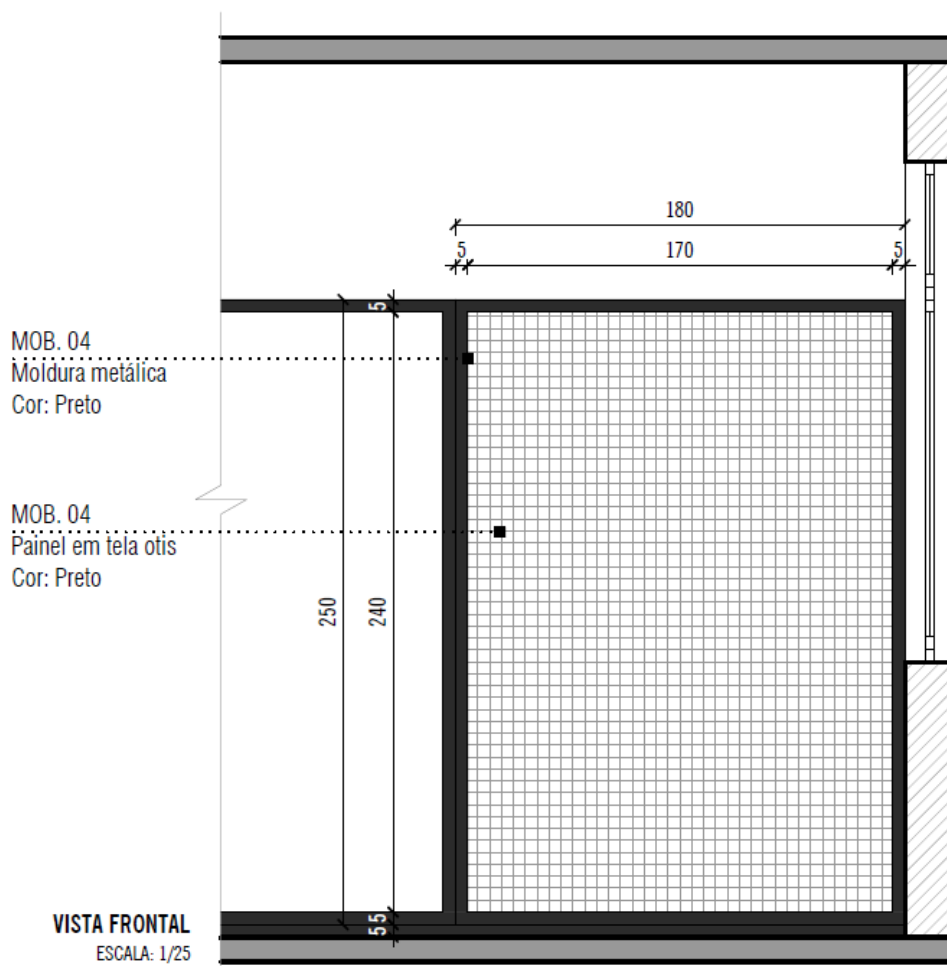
Painel aramado, conforme dimensões indicadas em projeto
